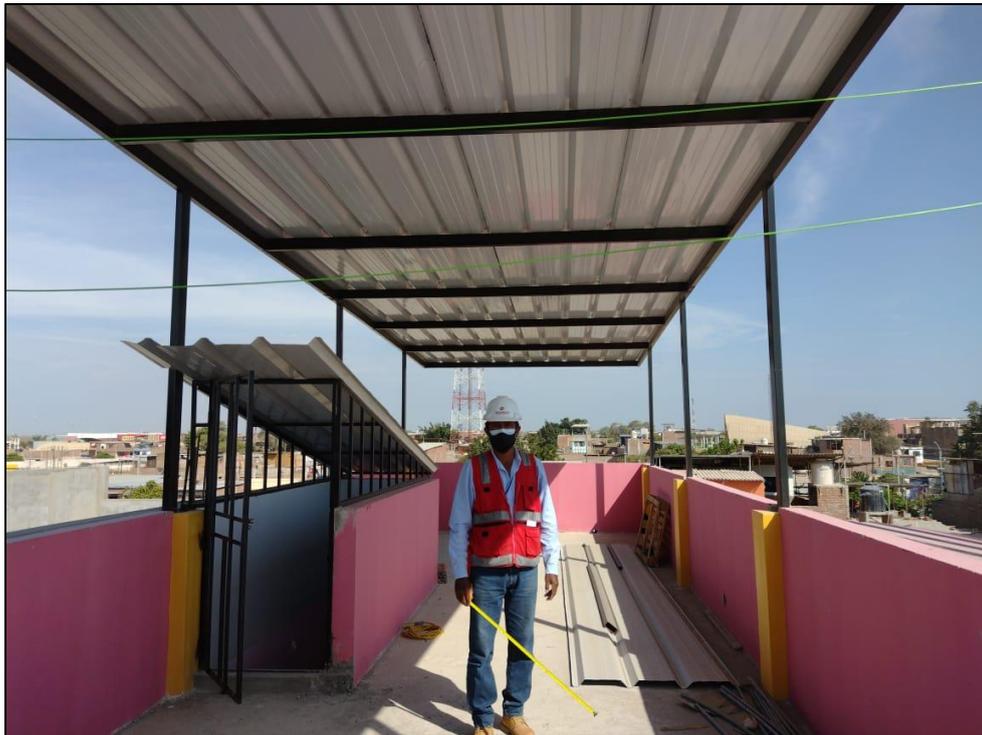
Vivienda del Barrio Buenos Aires, Calle 4 # 617, Cubierta
